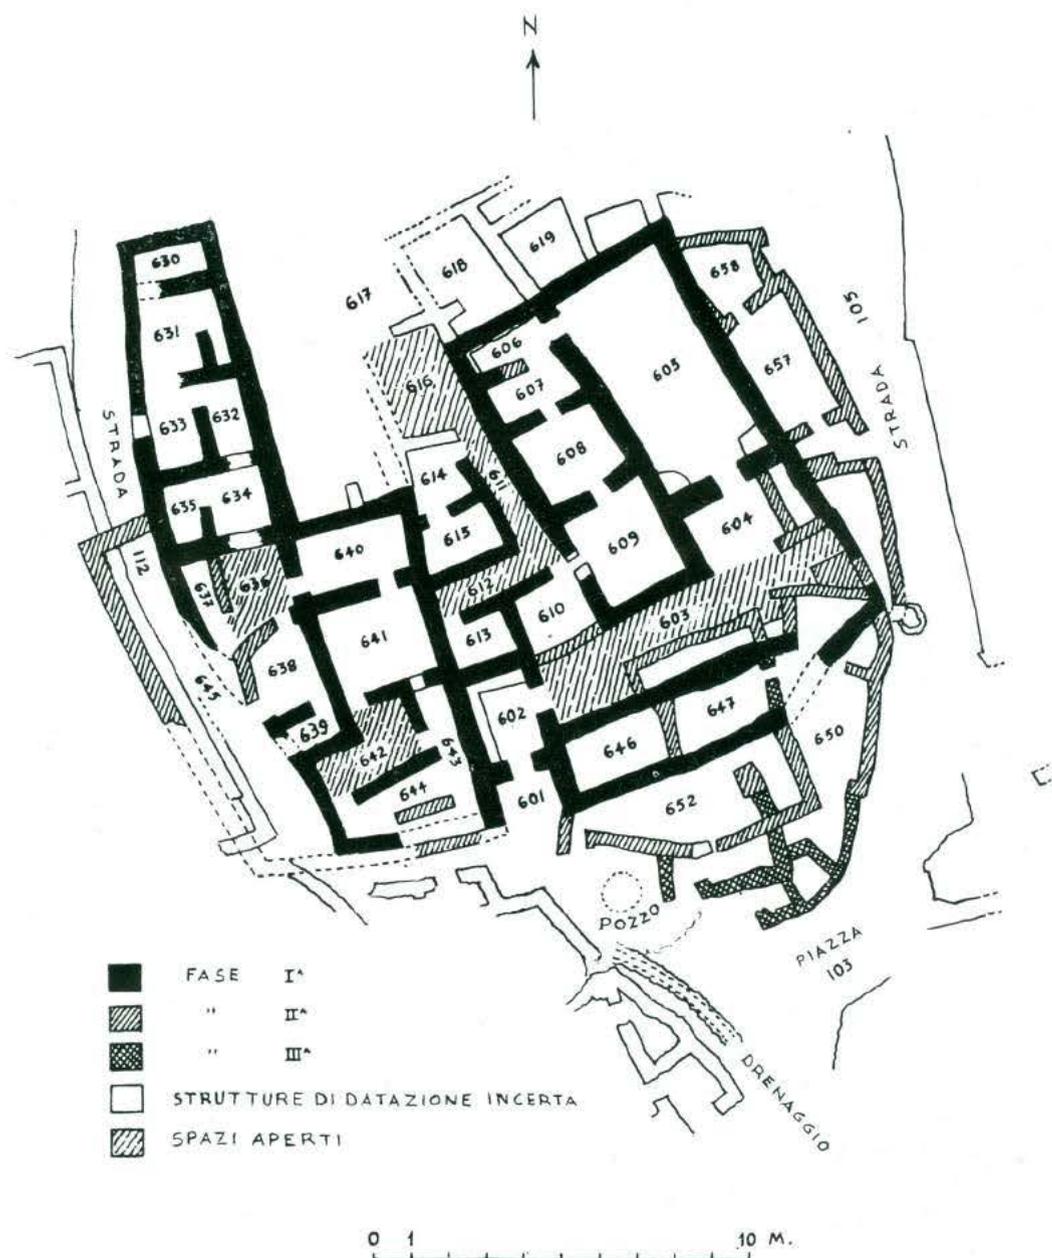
ISOLATO VIII: PLANIMETRIA GENERALE CON INDICAZIONE DELLE DIVERSE FASI COSTRUTTIVE.
